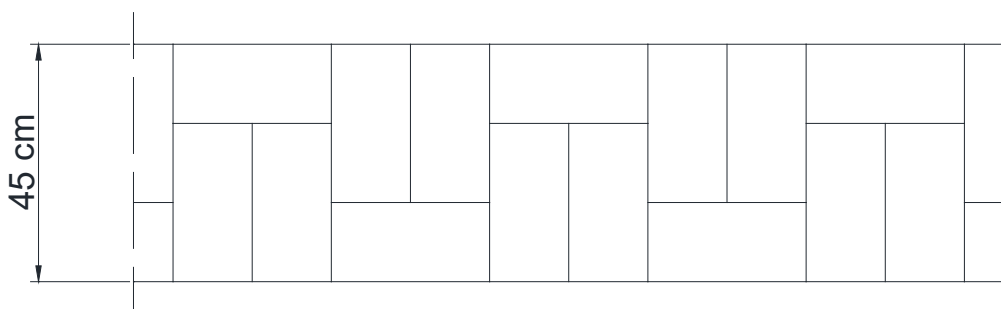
Muratura sezione C. (realizzato con Autocad)
